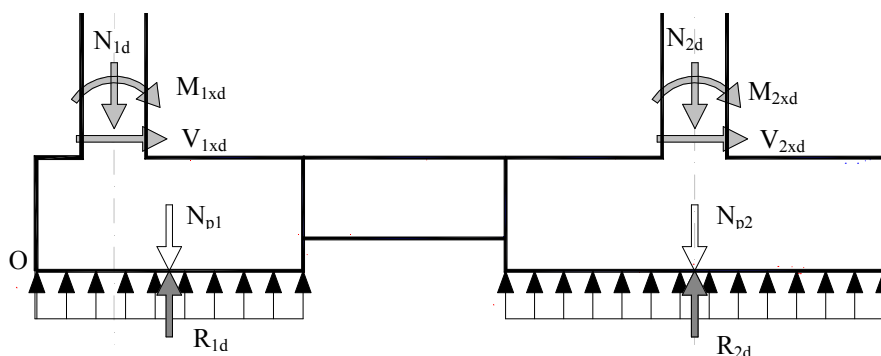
Zapata Excéntrica con Viga Riostra. Modelo Rígido. Equilibrio.
